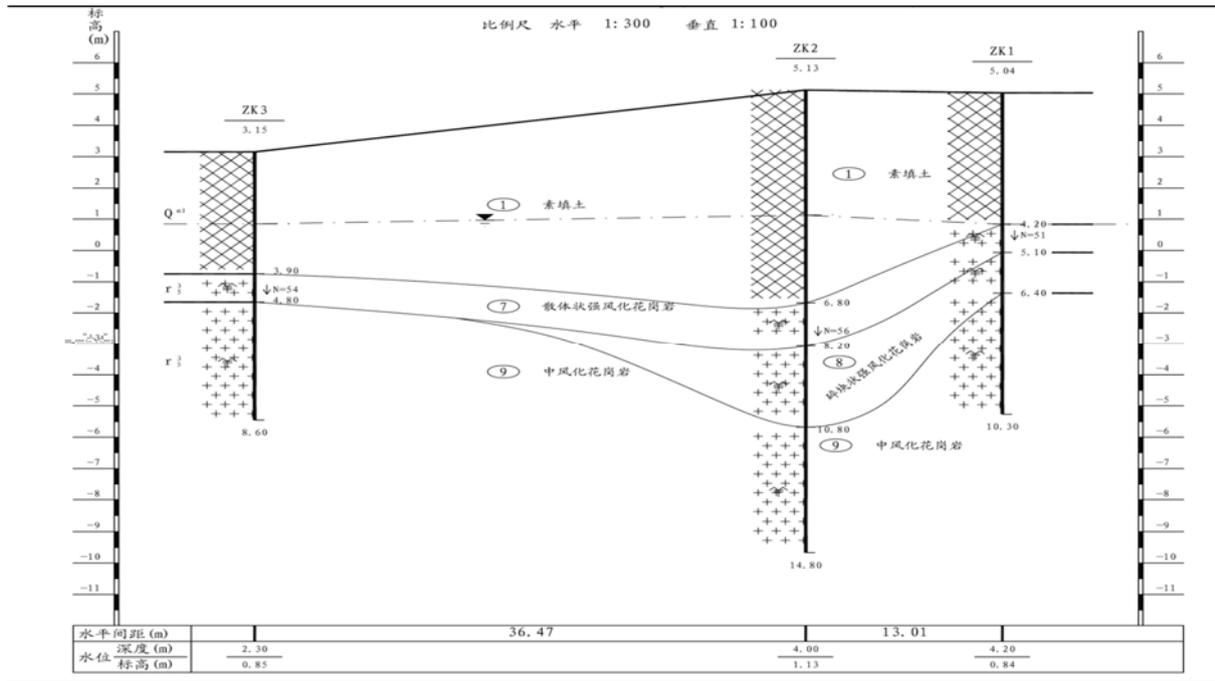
八尺门海堤钻孔剖面图 (一)
